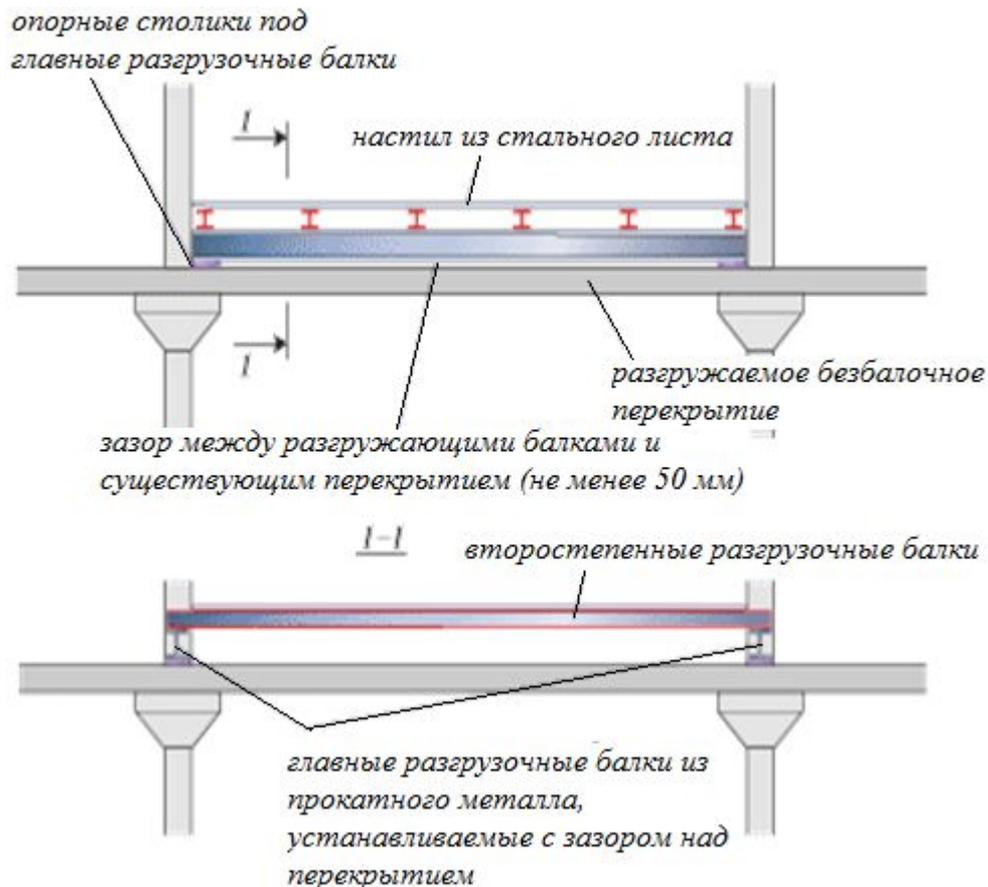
Усиление разгружающими балками сверху перекрытия
